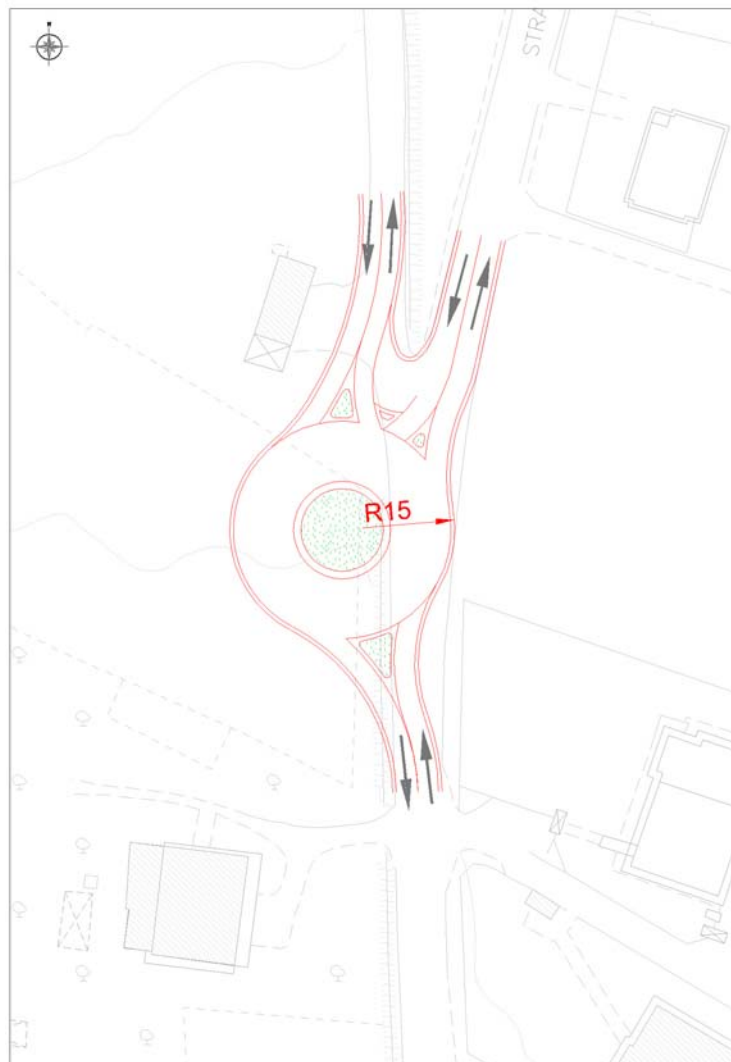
Intervento V11 - Layout nuova sistemazione dell'intersezione
